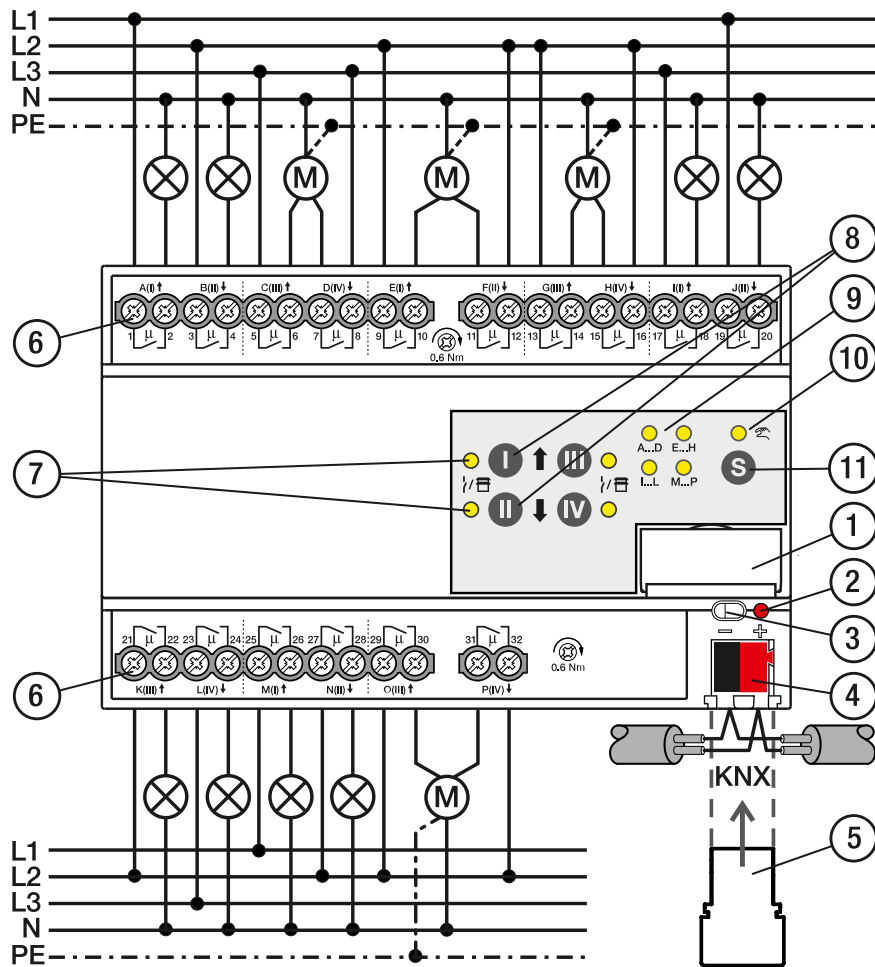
Schema di collegamento SAH/S 16.x.7.1
